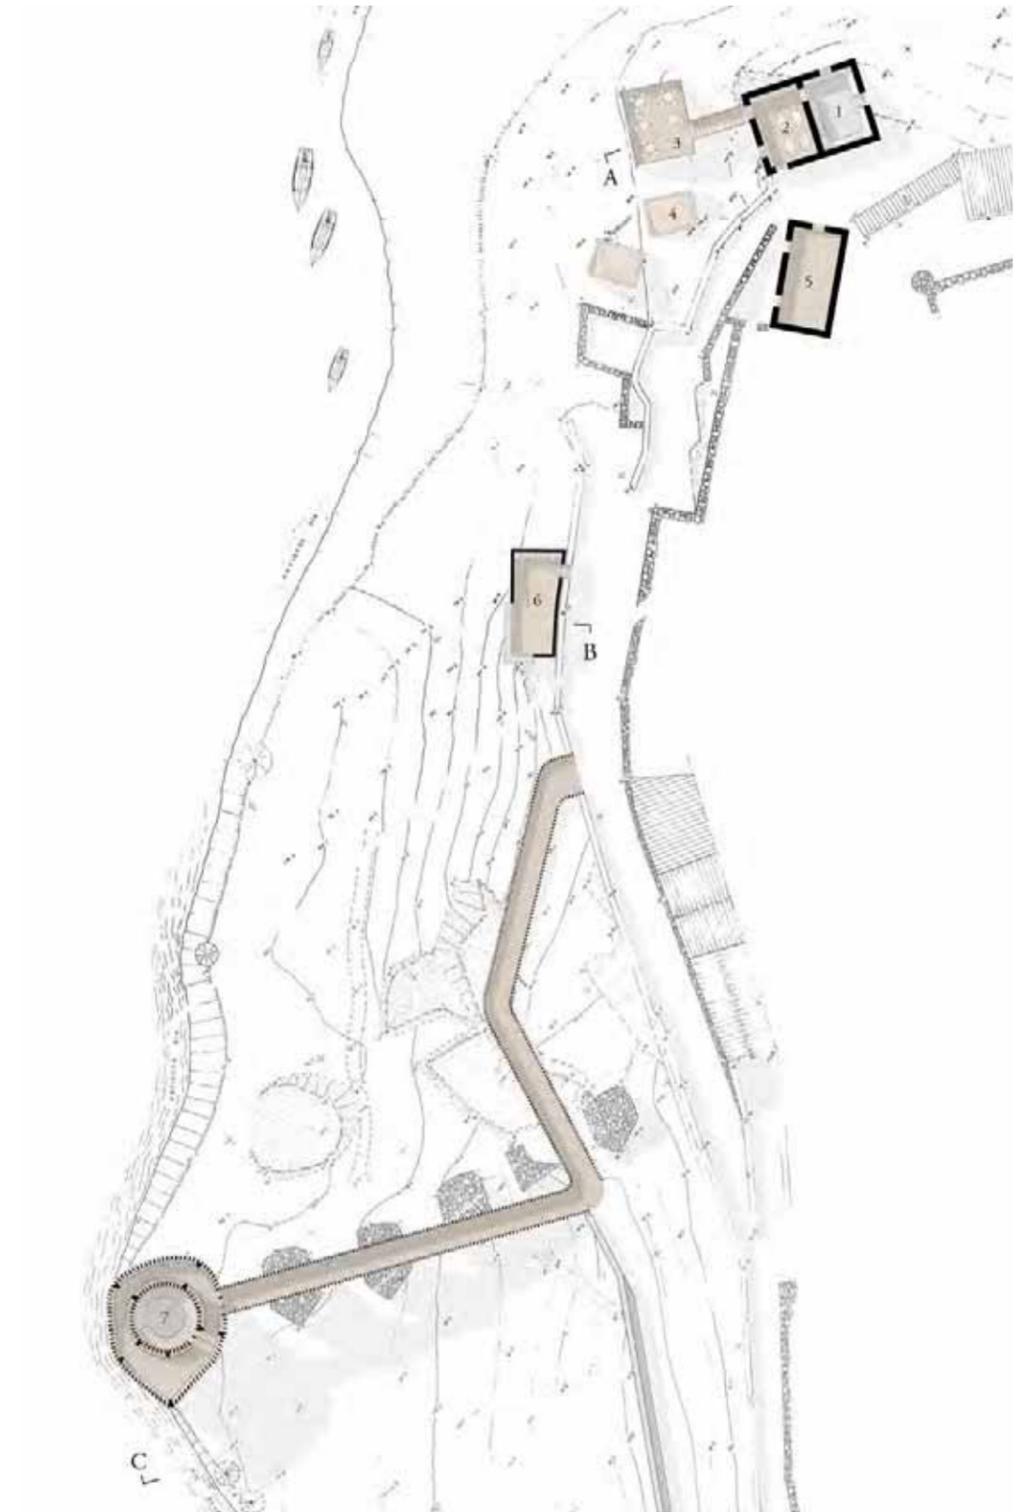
Planta geral: zona do antigo bairro portuário, José Esteves, 2017
